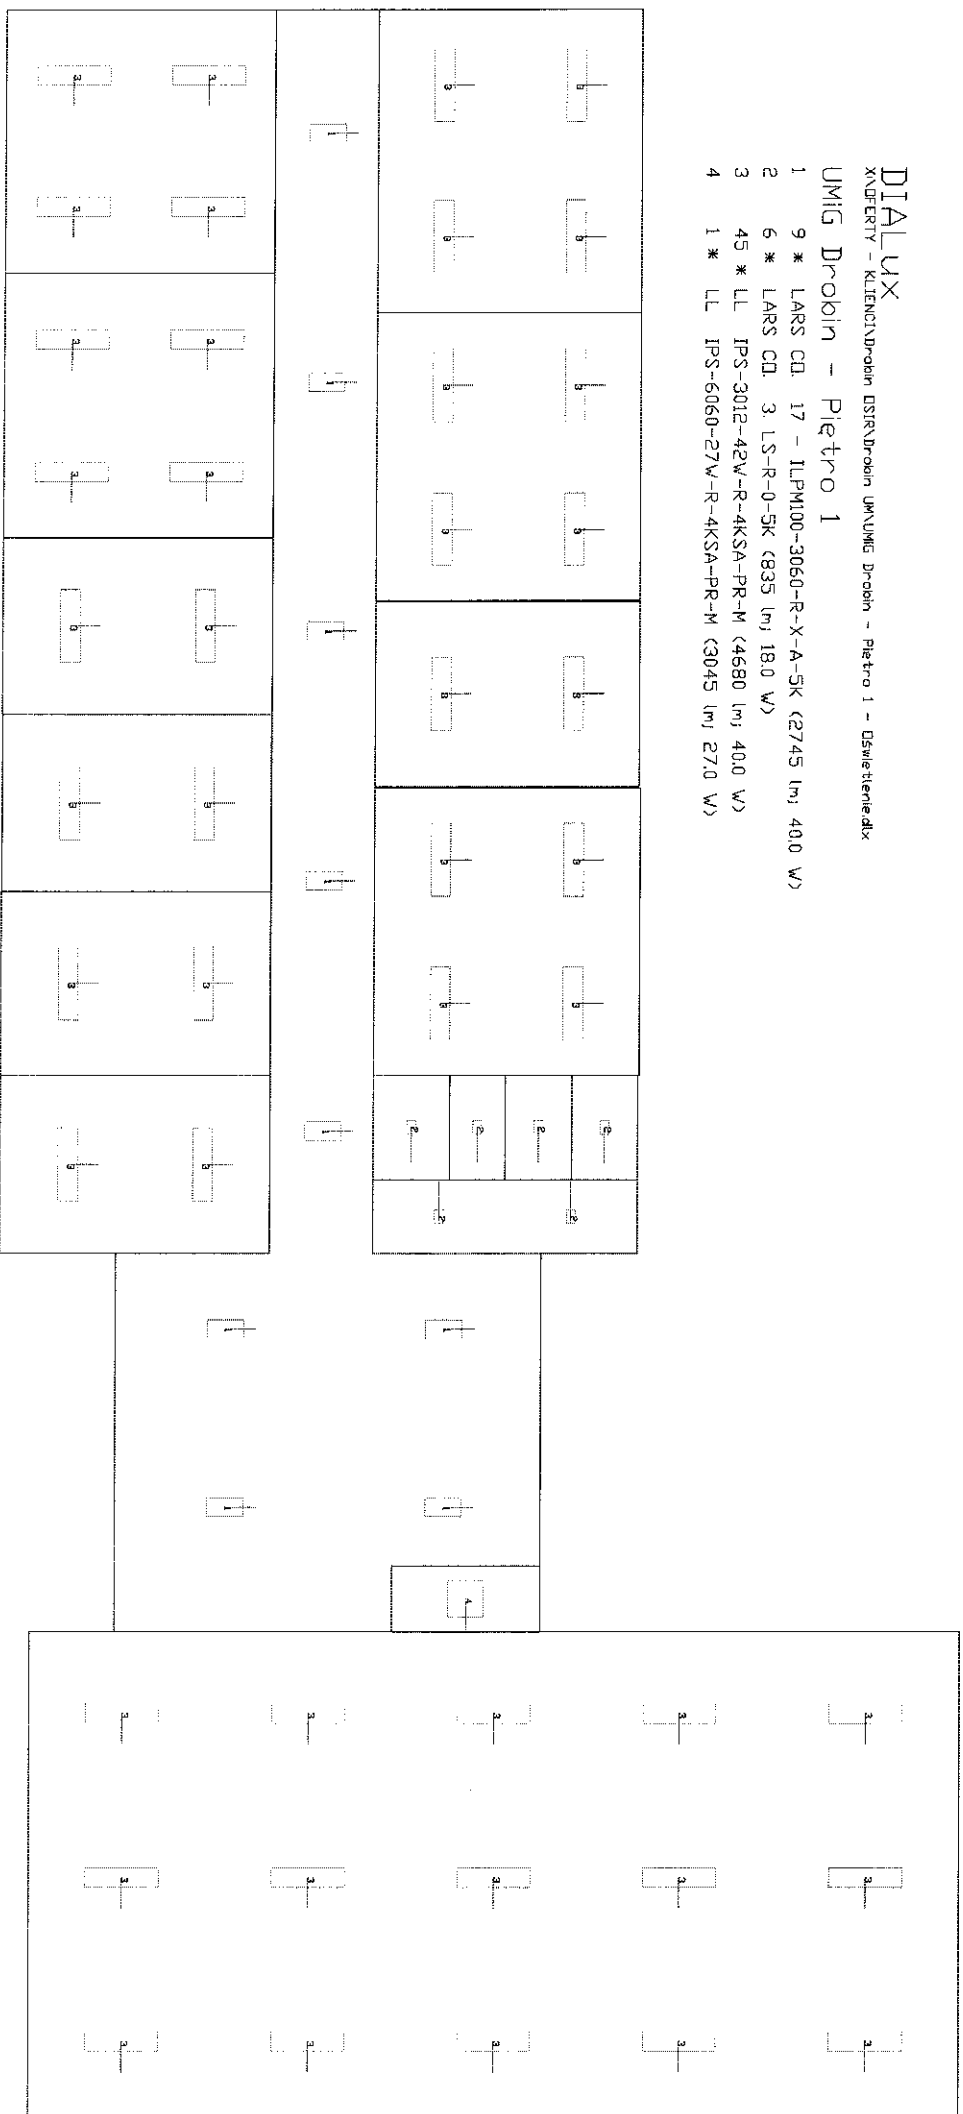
Plan Instalacji Oświetleniowej - Urząd Miasta i Gminy Drobin – PIĘTRO
